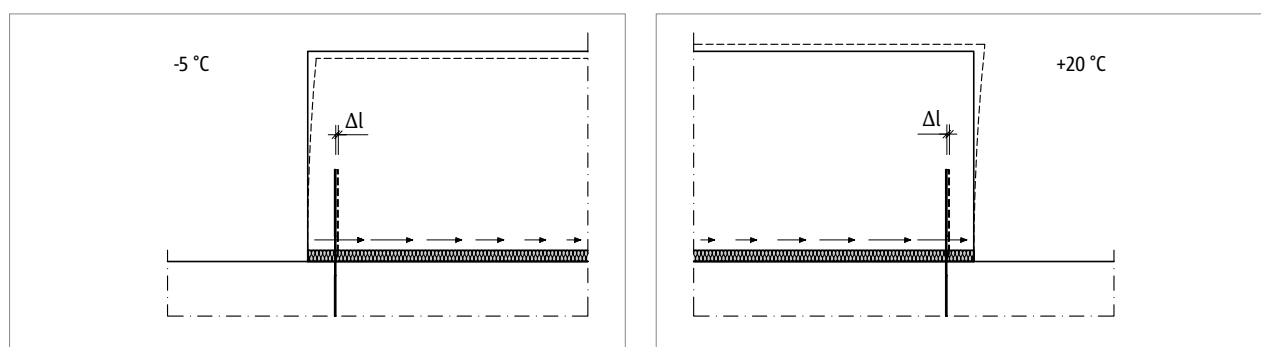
Schöck Isokorb® : Déplacement des barres extérieures d'une dalle de balcon de Δl en raison d'une déformation thermique
